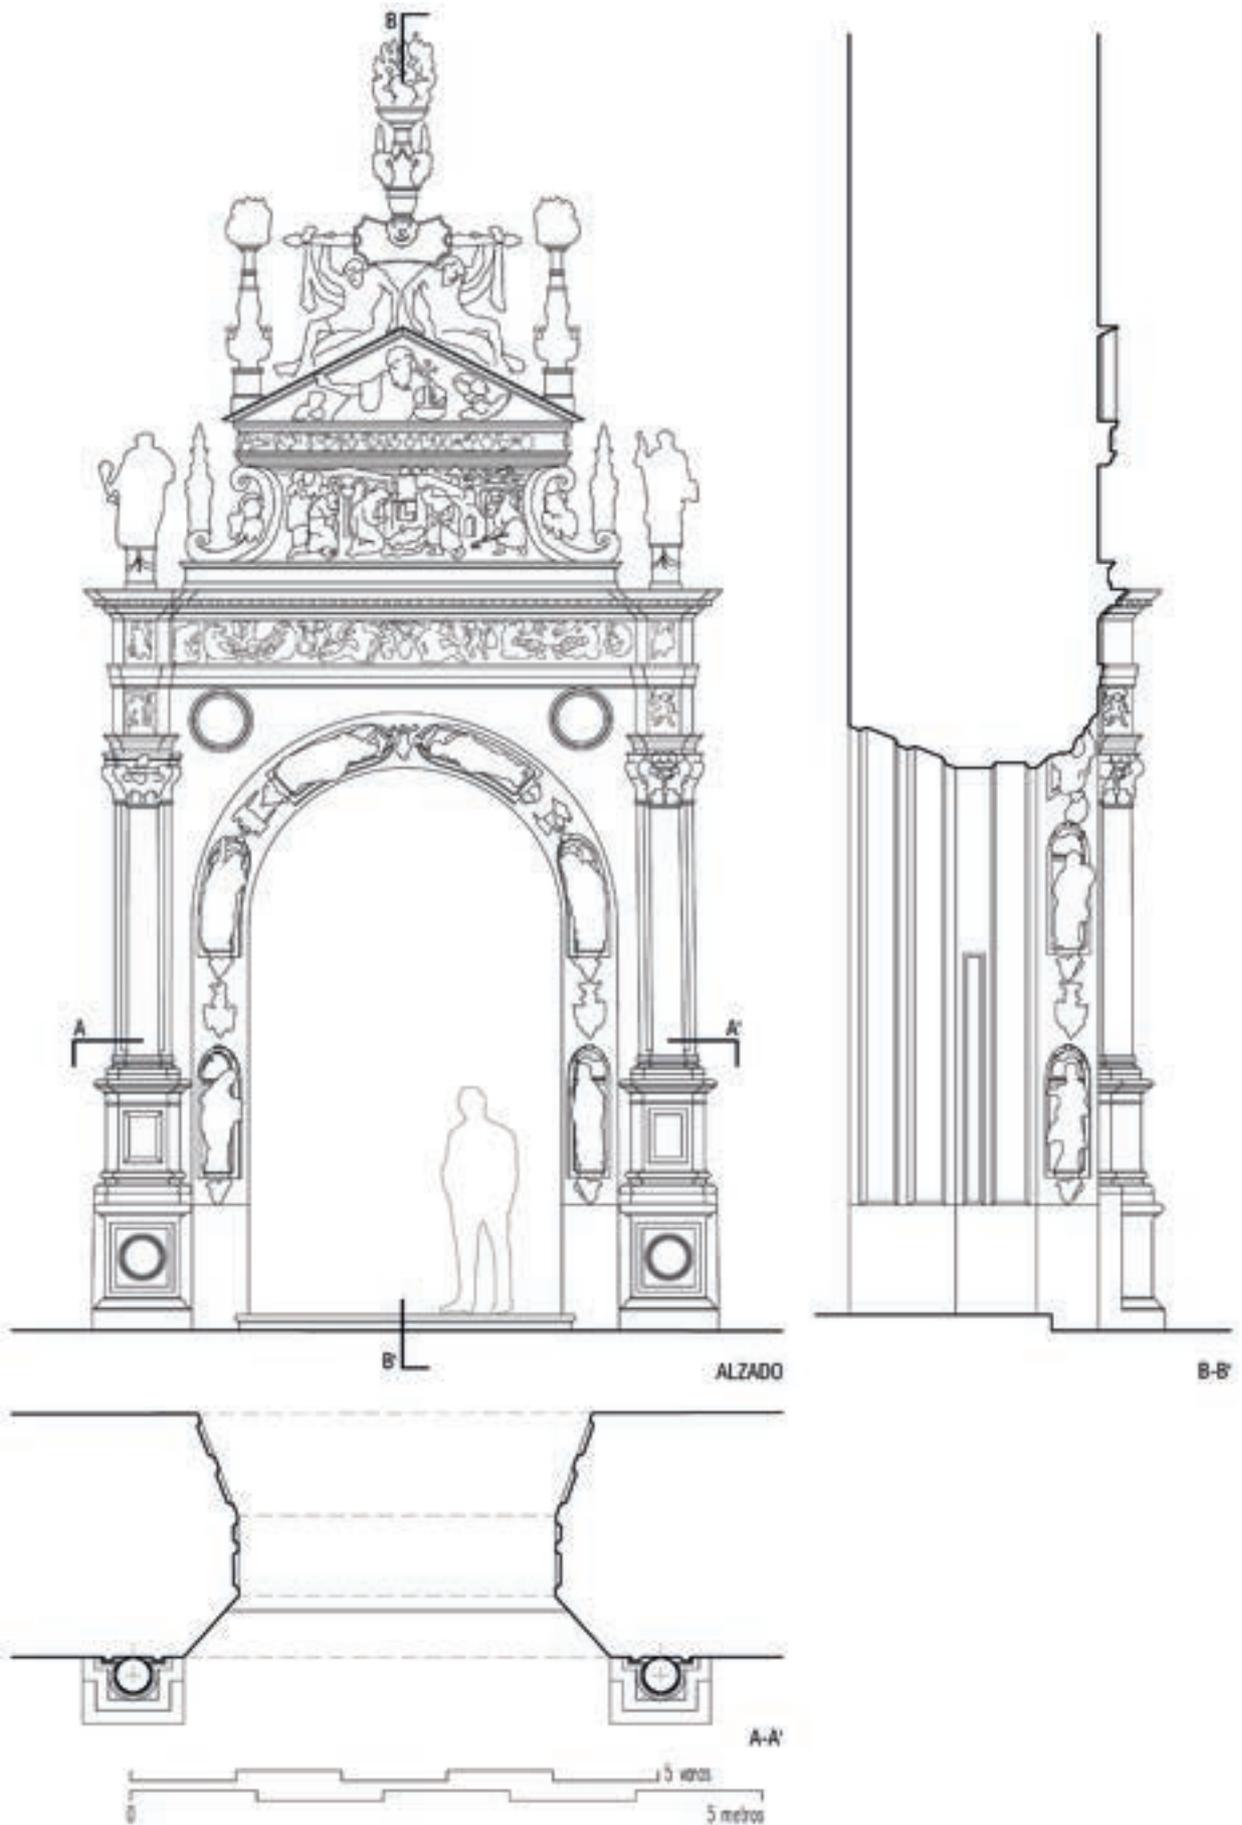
Planta, alzado y sección de la portada. Dibujo de los autores
